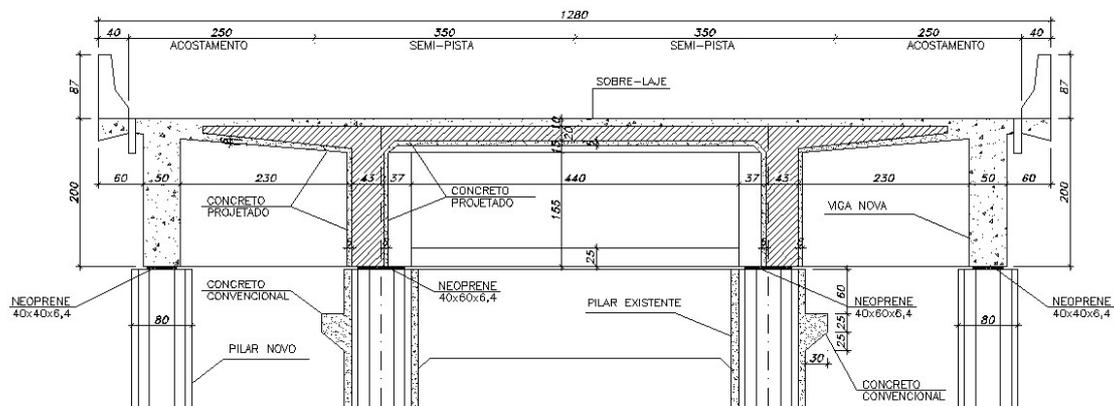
Seção transversal do alargamento de uma ponte com a adição de novas vigas e pilares de concreto armado sem necessidade de reforço das vigas antigas. (Fonte: VITÓRIO, 2013)
